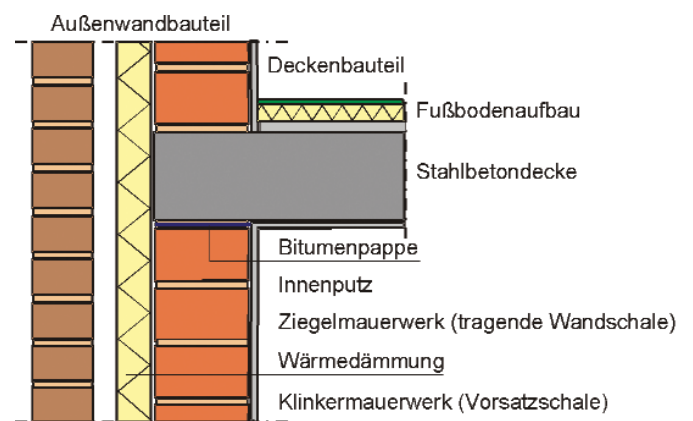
Möglichkeit eines Anschlusses der Stahlbetondecke an eine zweischalige massive Außenwand aus Ziegelmauerwerk nach [16]
